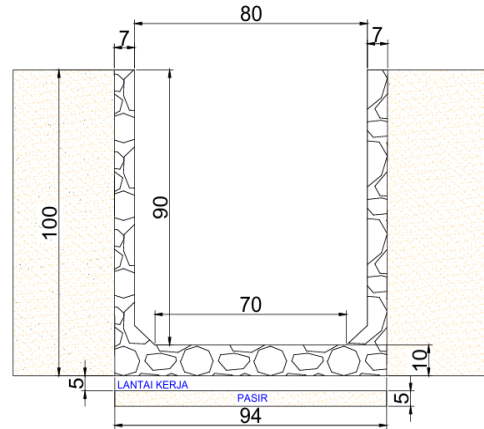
Dimensi Rencana Konstruksi Beton Baru 2D
